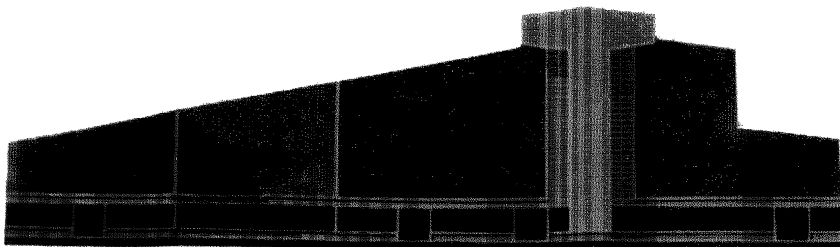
Цветовое решение на основе выделения отдельных элементов фасада
